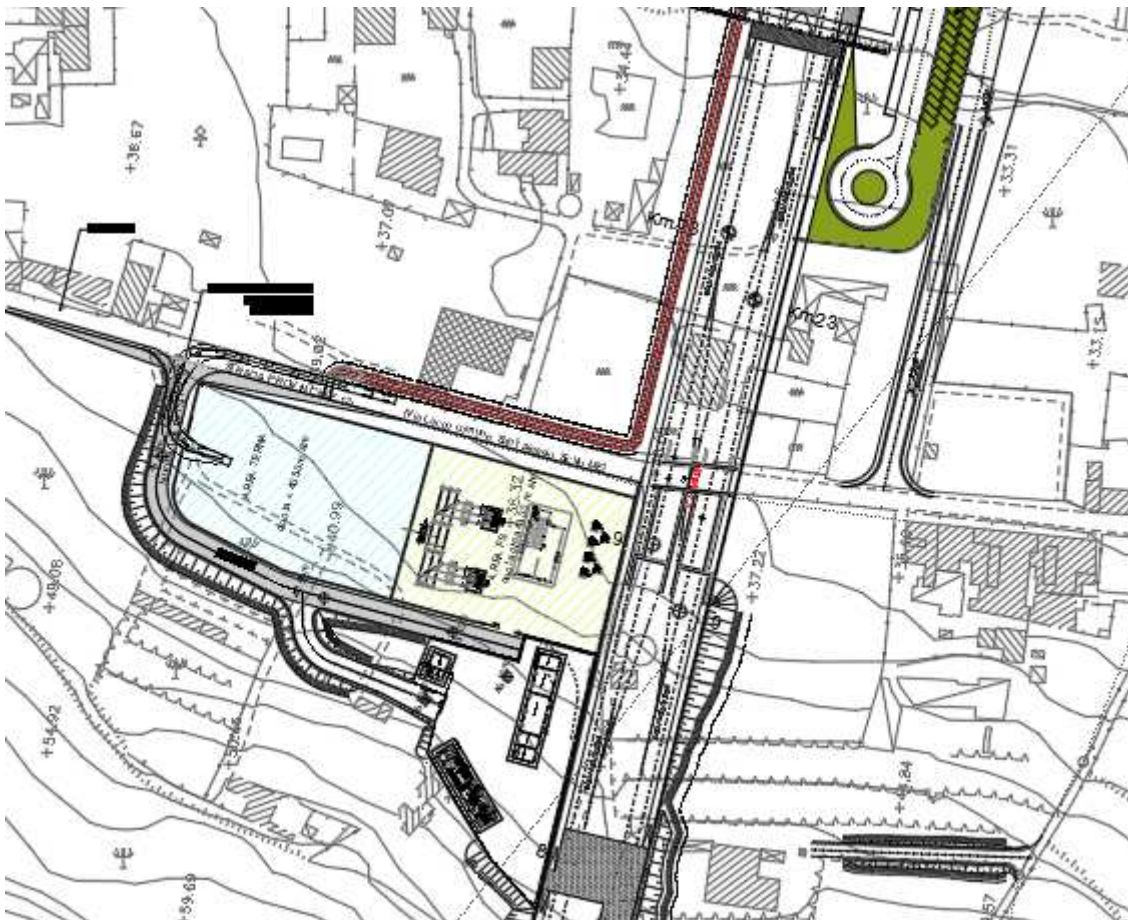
Stralcio planimetria SSE di Sant'Alessio (ME)
